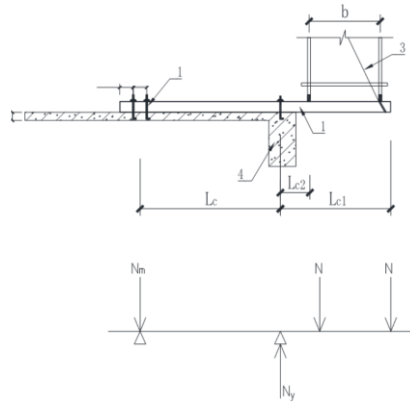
悬挑脚手架型钢悬挑梁构造与计算示意
